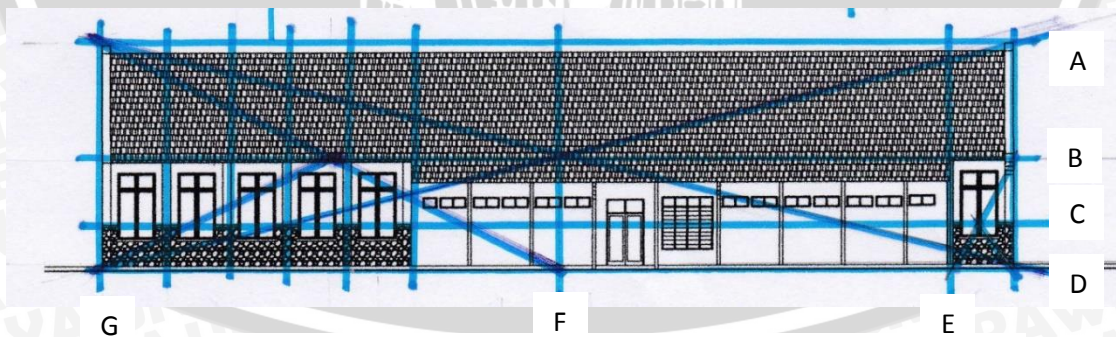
Proporsi *Golden Section* tampak belakang gedung Serba Guna
